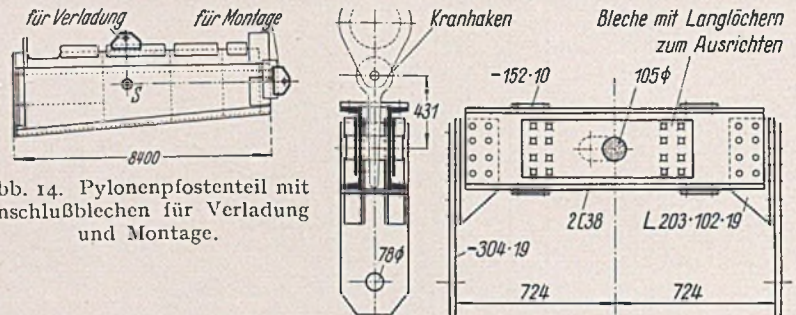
Pylonenpfosten mit Anschlußblechen für Verladung und Montage.
